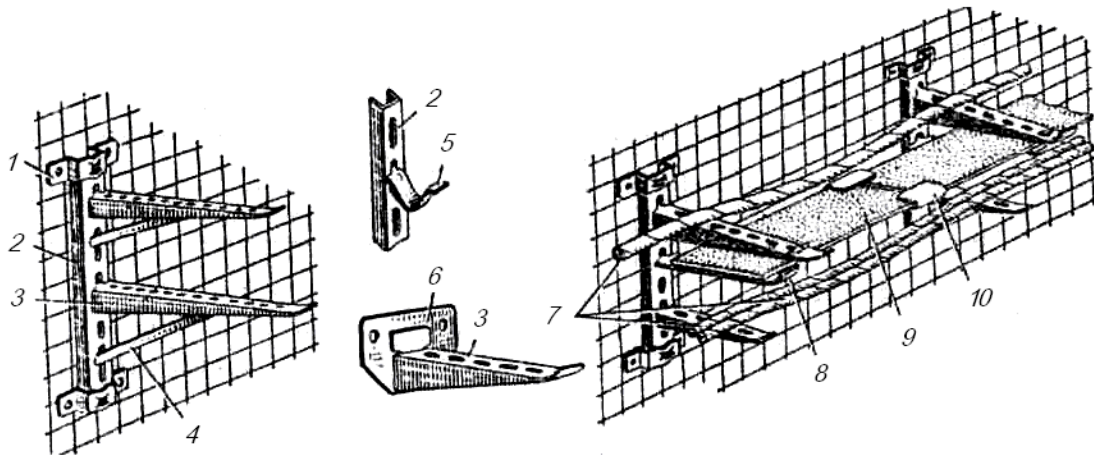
Опорні конструкції (а) і приклад прокладання кабелів на, опорних конструкціях (б): — хомут кріплення стояка з полицею до стіни; 2 — стояк; 3 — полиця; 4 — підкіс; 5—кабельна скоба; 6 — плита; 7 — кабелі; 5 — скоба кріплення ізоляційної перегородки; 9 —ізоляційна перегородка; 10 — затискачі стиковки і кріплення ізоляційної перегородка
